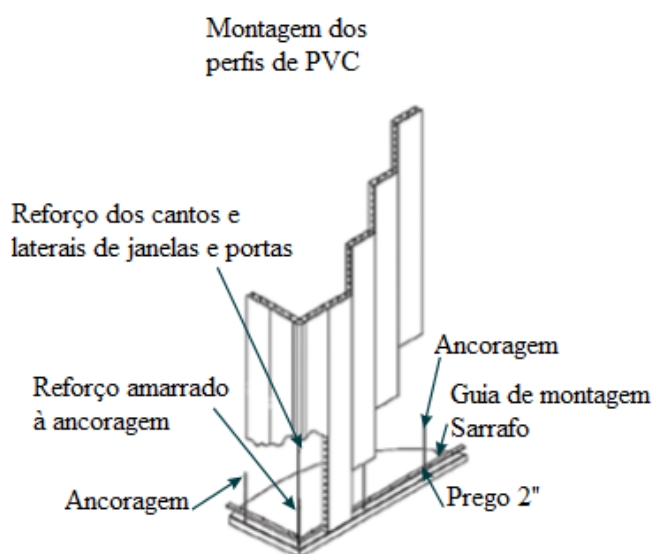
Estrutura da parede do Sistema Concreto PVC
